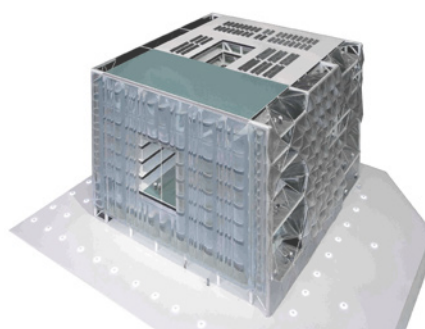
FACHADA SUDOESTE (LADO ESQUERDO)
